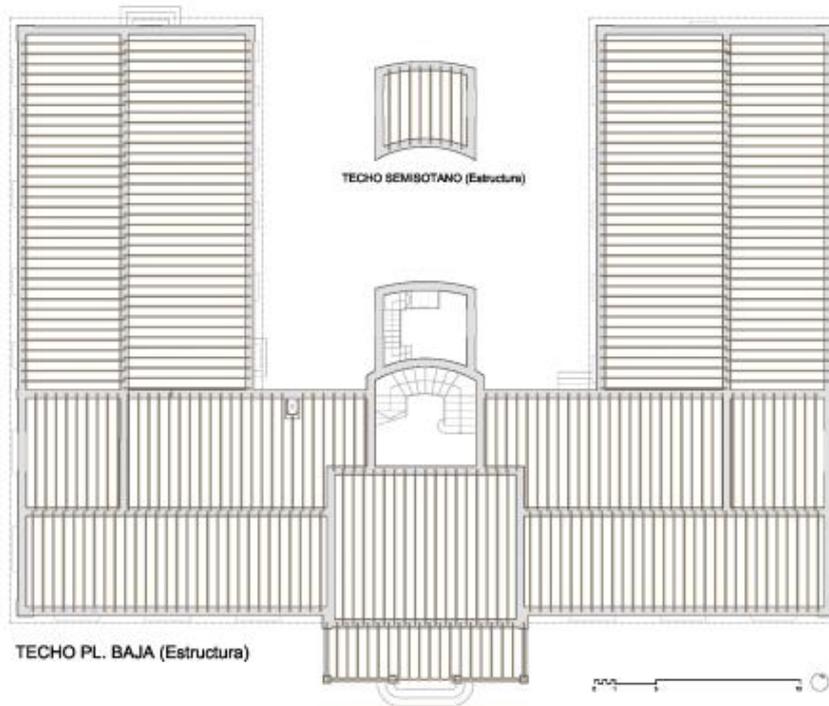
Esquema estructural de planta baja. Orenes García, Matías J., 2015.
